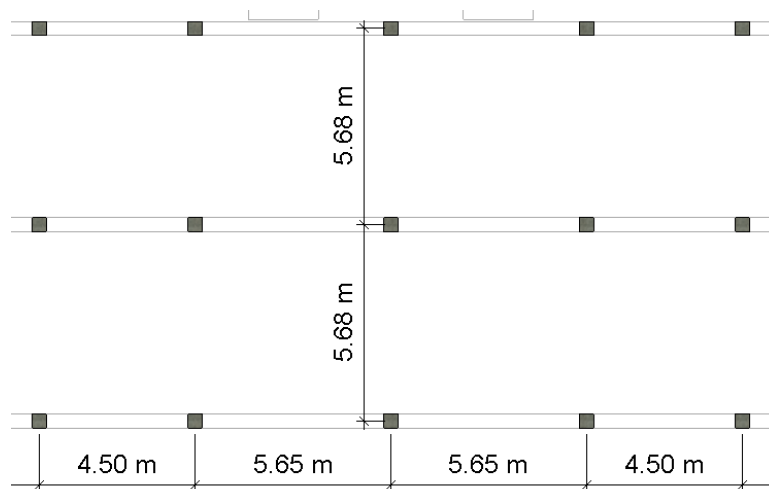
Fragmento de plano de planta estructural donde se pueden apreciar distancias regulares entre vigas y columnas. Fuente: elaboración propia
